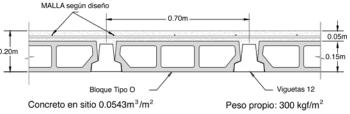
Detalle típico de entrepisos de vigueta de 12 cm con bloque tipo O
